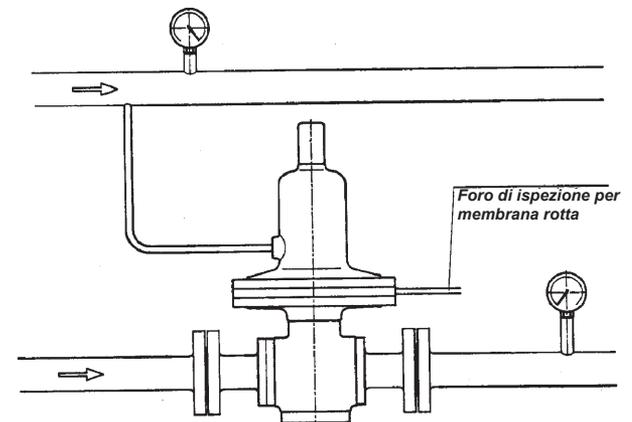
Esempio di layout dell'installazione – regolatori Gruppo 2: 172-50 Membrana doppia
